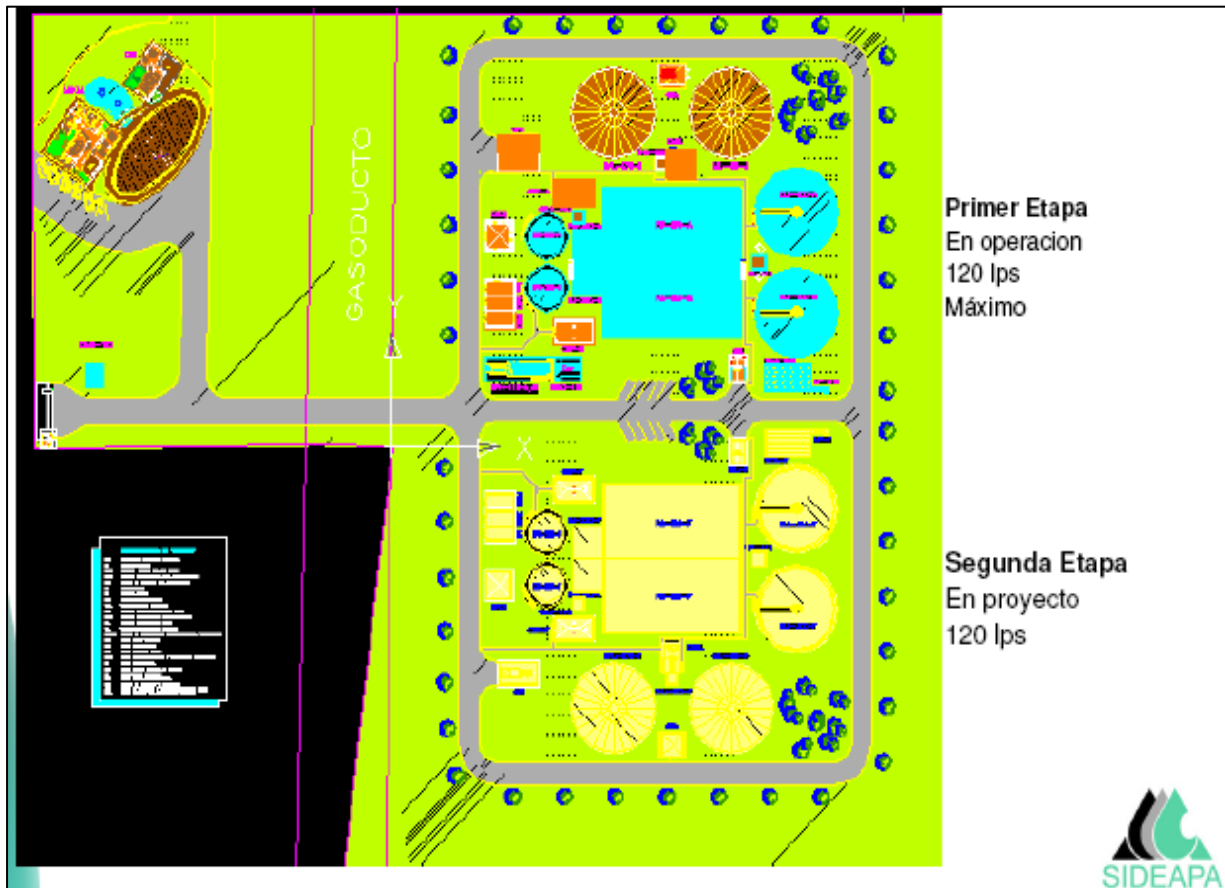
Esquema general de Planta de Tratamiento Oriente
